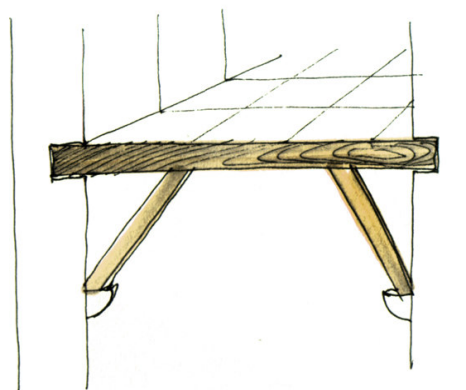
Reforço de pavimentos através da introdução de mãos-de-amigo ou braços em madeira
